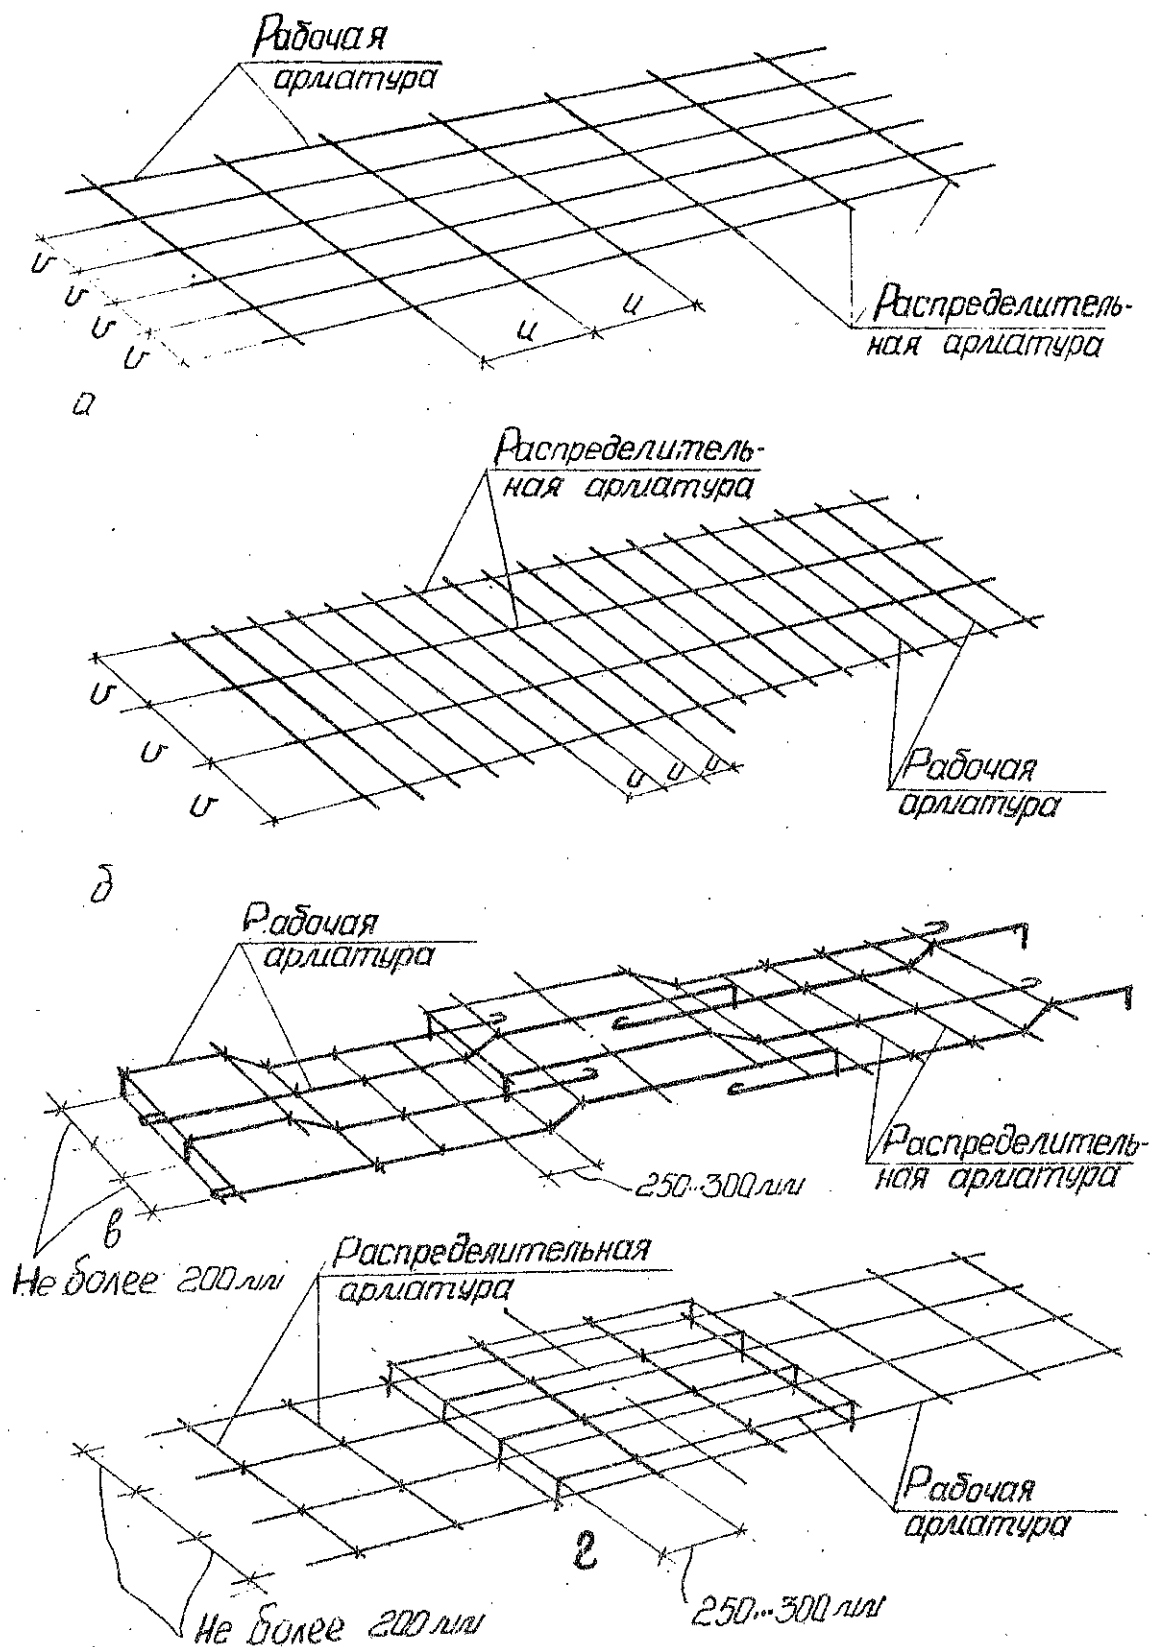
Сварные рулонные и вязаные сетки: а - сварные с продольной рабочей арматурой; б - сварные с поперечной рабочей арматурой; в - вязаные с отогнутыми стержнями; г - вязаные с прямыми стержнями
